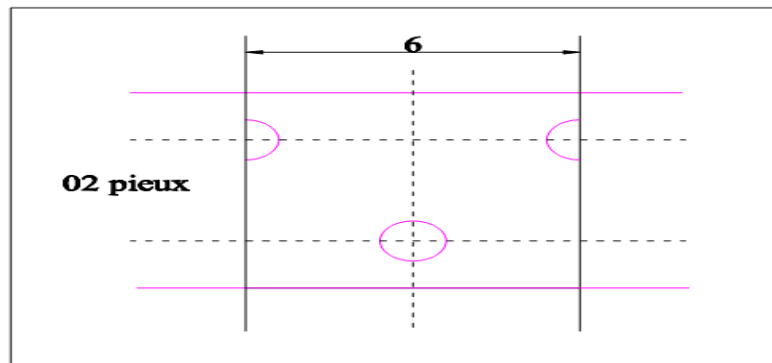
Implantation des pieux en plan (Position alternée).
